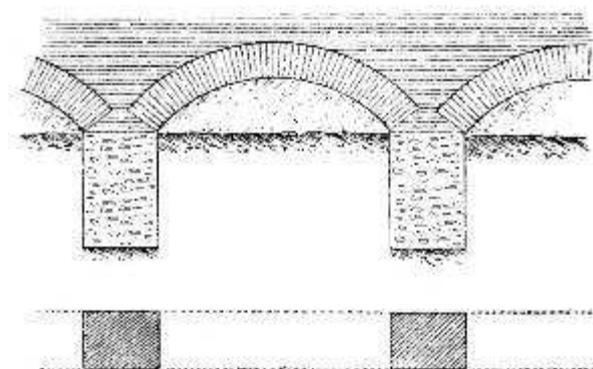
Fondazione a pilastri ed archi (GELATI 1899, rielab. dell'autore)
